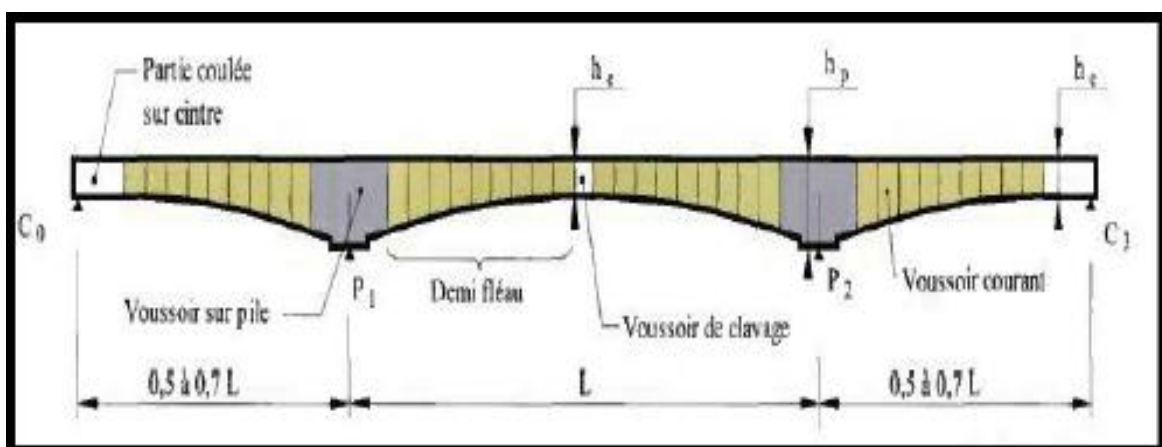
Profil en long d'un tablier construit en encorbellements successifs.
